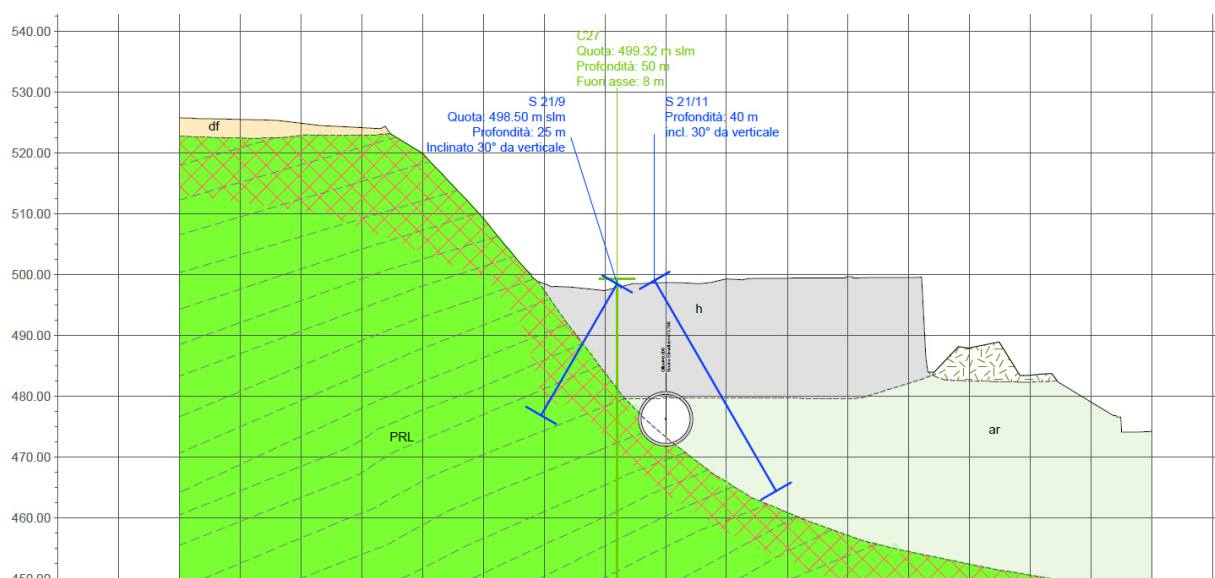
Stralcio del planoprofilo di dettaglio dell'imbocco binario dispari con la sezione trasversali all'altezza delle pk 3+120 attraverso il rilevato dell'autostrada A22- elaborato IBOU1BEZZL7GE0001006B.
